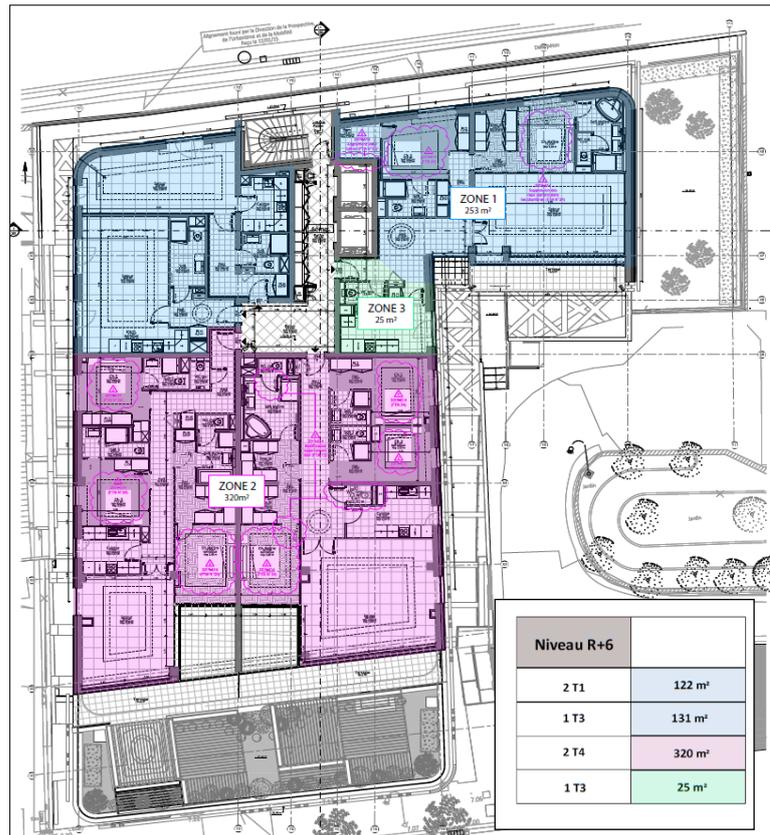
Divisione delle aree di lavoro del sesto piano (R+6)
